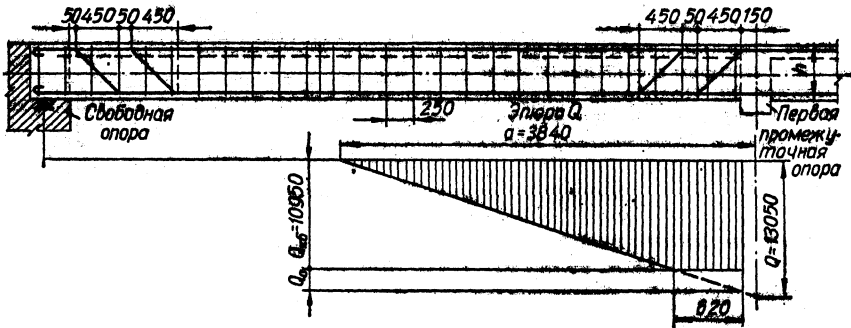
Армирование балки отдельными стержнями и отгибами.
